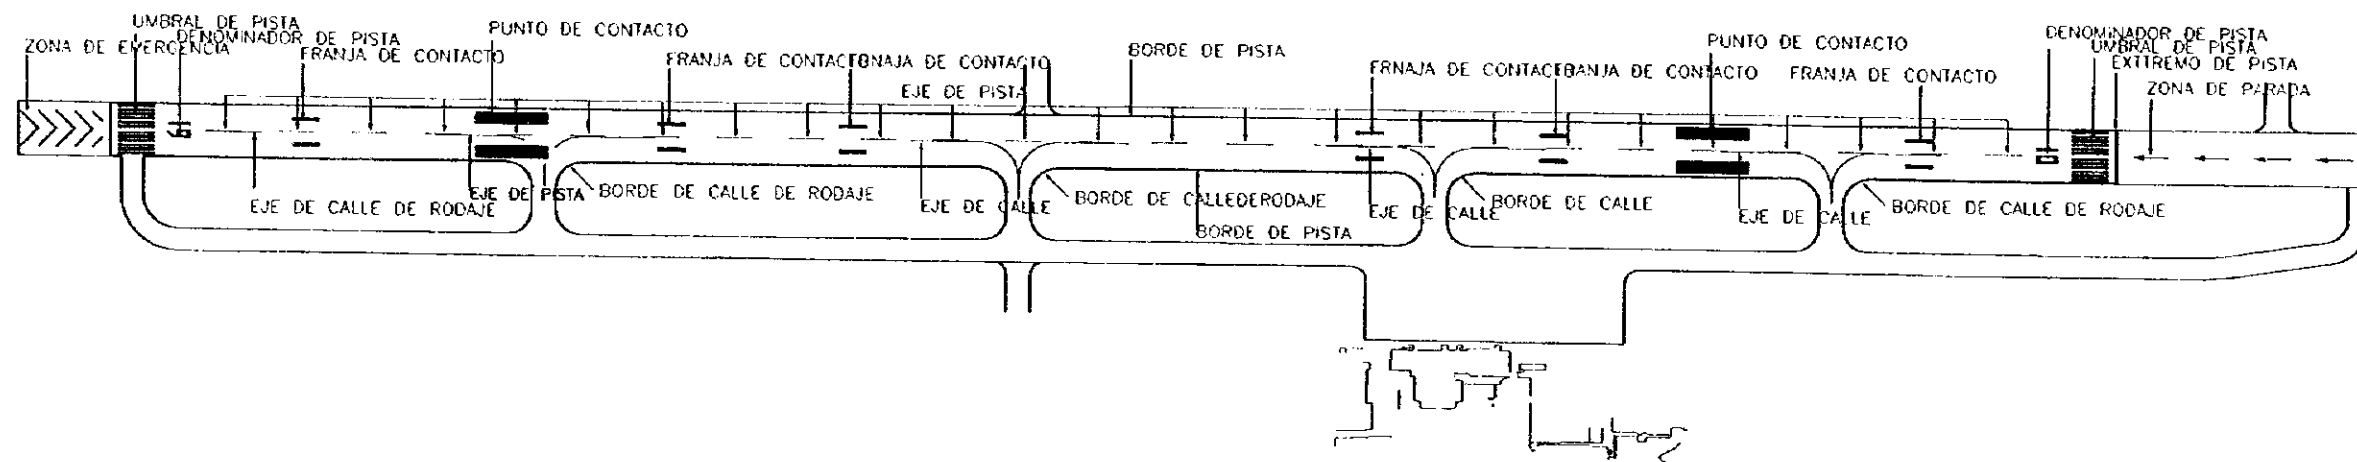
a Plano de Detalle de Señales Superficiales (Primera Fase)
